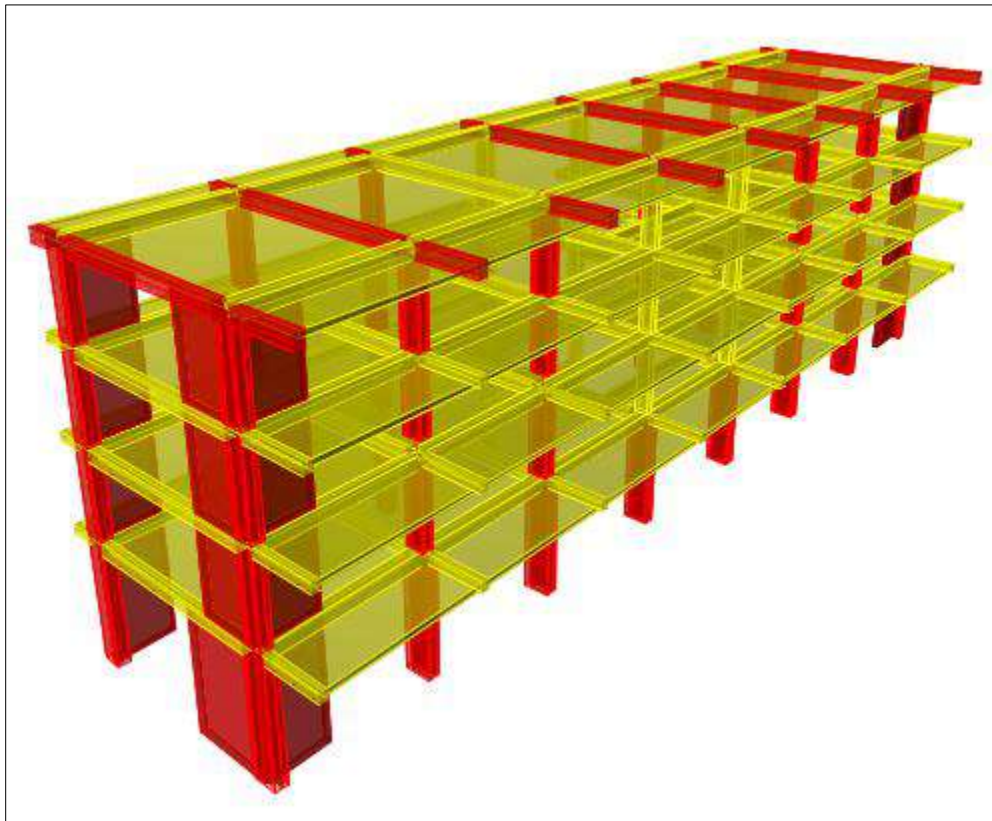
Esquema de elementos reforzados (nuevos y recalzados rojo)distribución de muros de reforzamiento N+0.00
